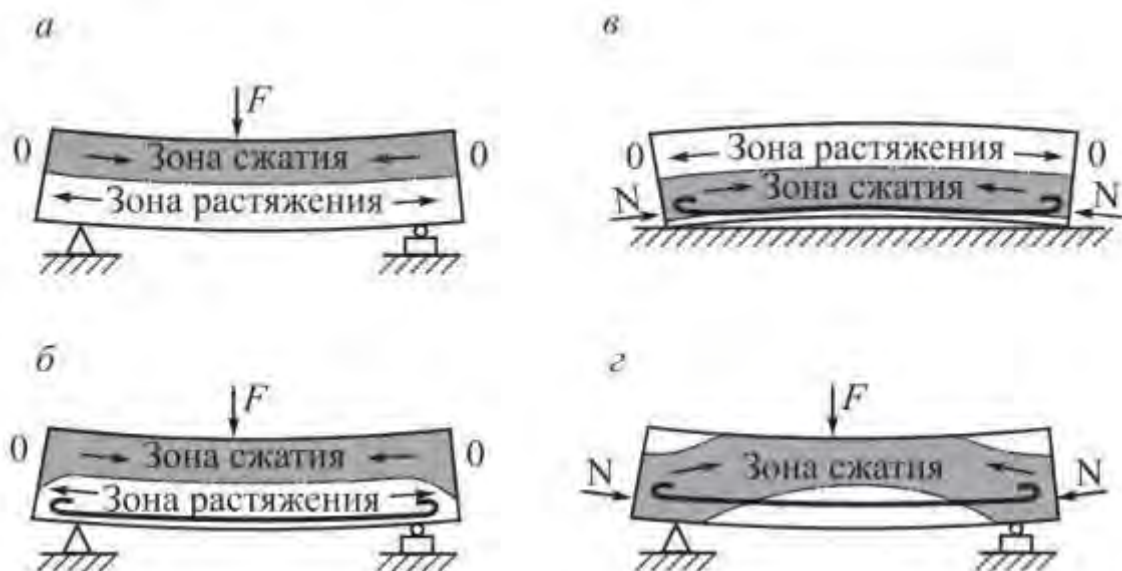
Схема работы бетонной и железобетонной балок:
